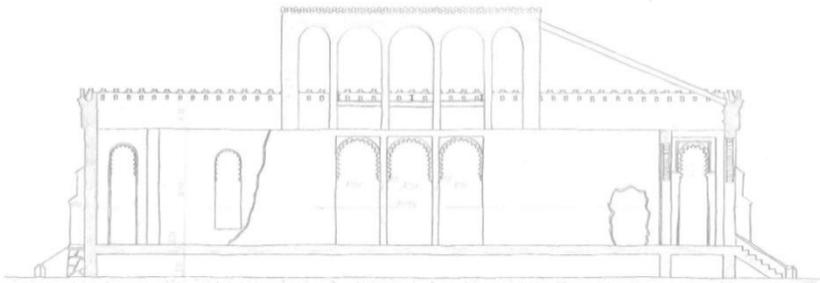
Croquis Sección Longitudinal (2014) - Fuente propia
